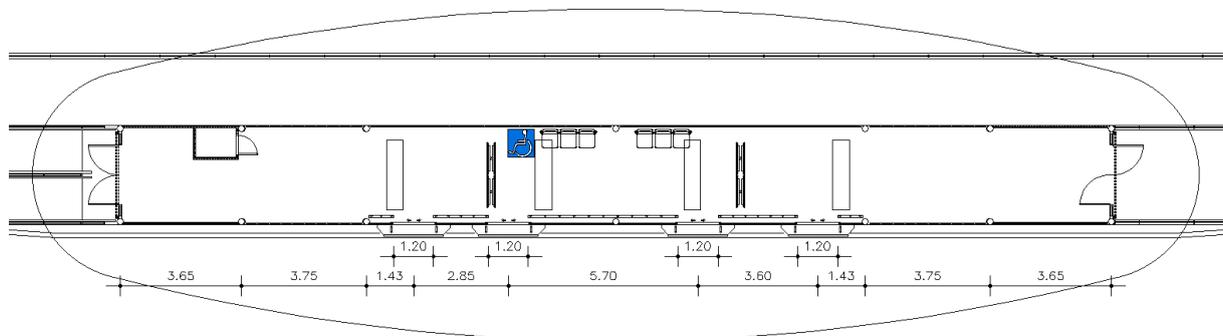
Planta da Estação de Passageiros na Avenida Almirante Barroso
